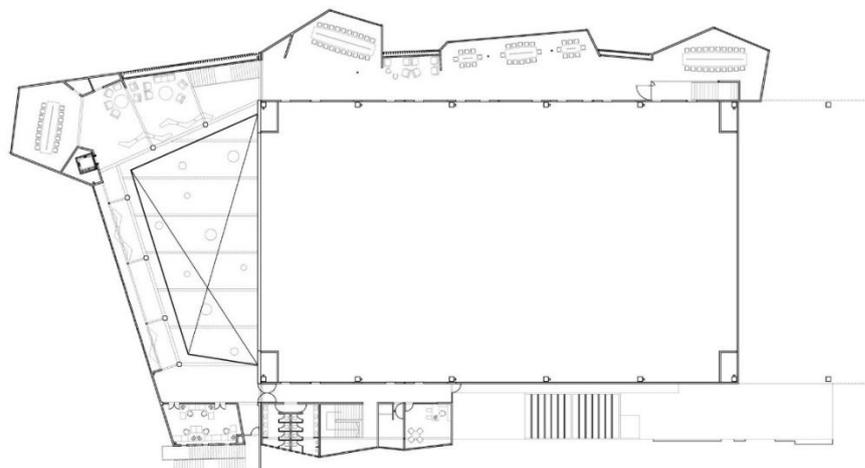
, Centro de Eventos Puente Verde- Plano Segundo Nivel
